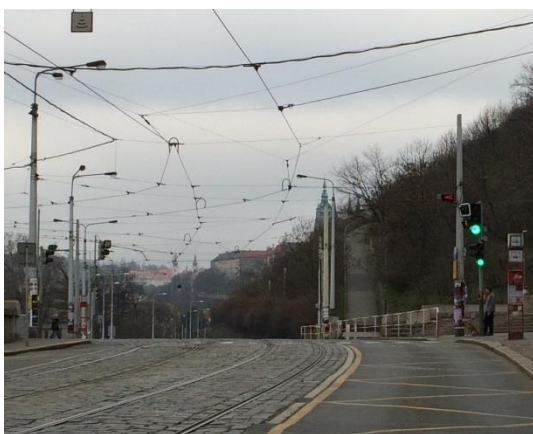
Detail hmat. úprav – sloupek SSZ
